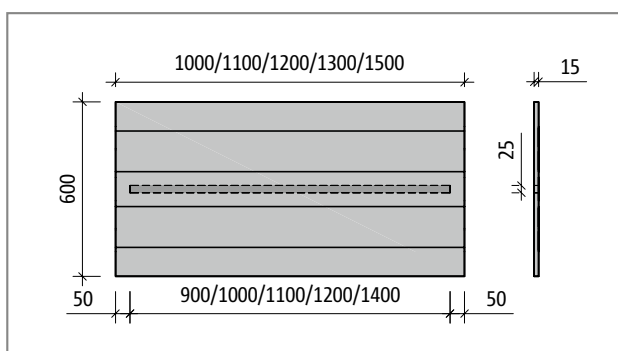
Schöck Tronsole® tipo B-V1-L...-B600, pianta del prodotto
